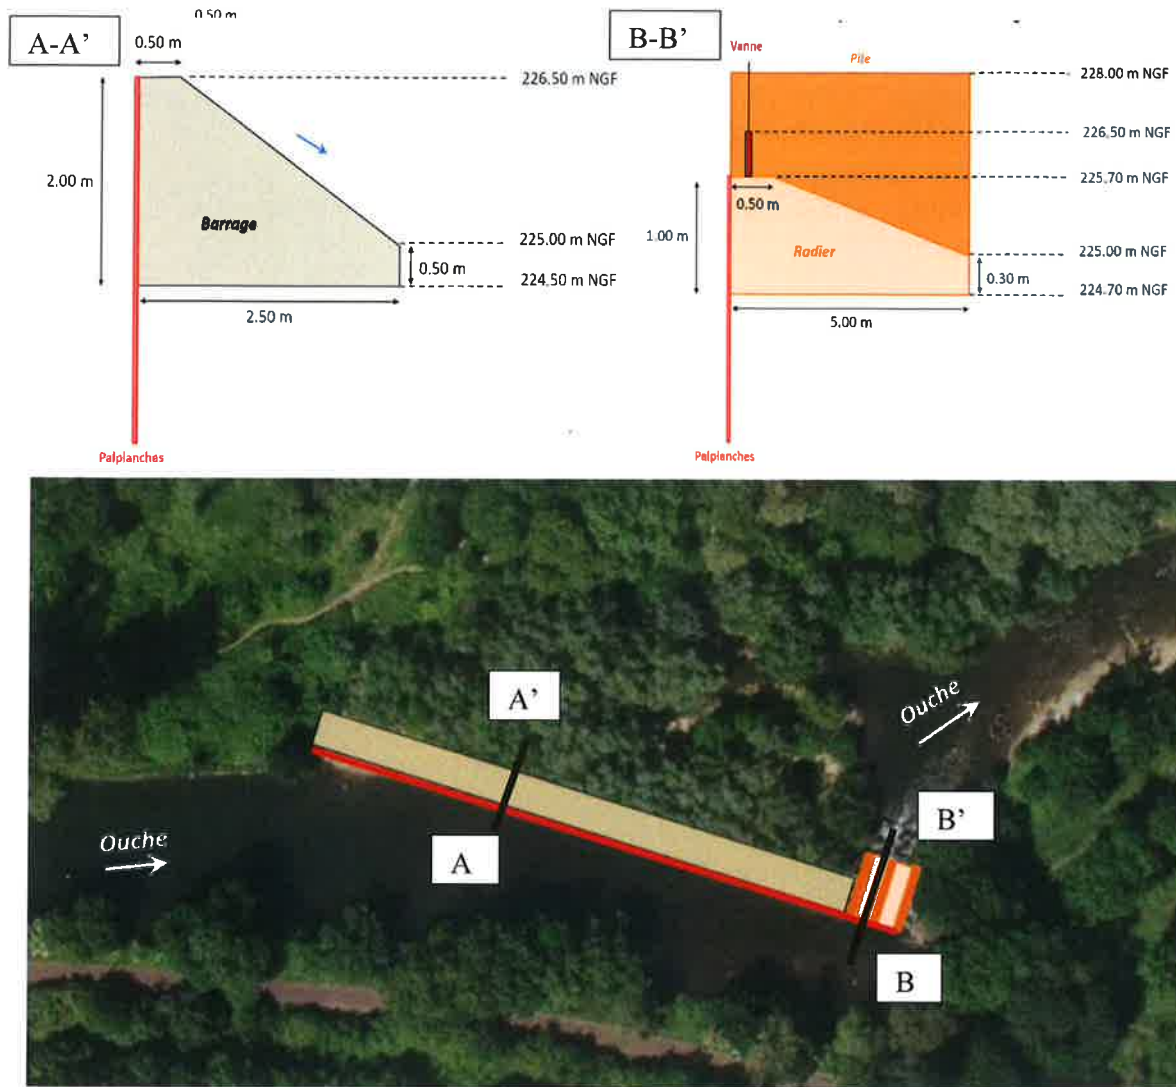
Vue en plan et coupes sommaire du barrage (sans échelle)
